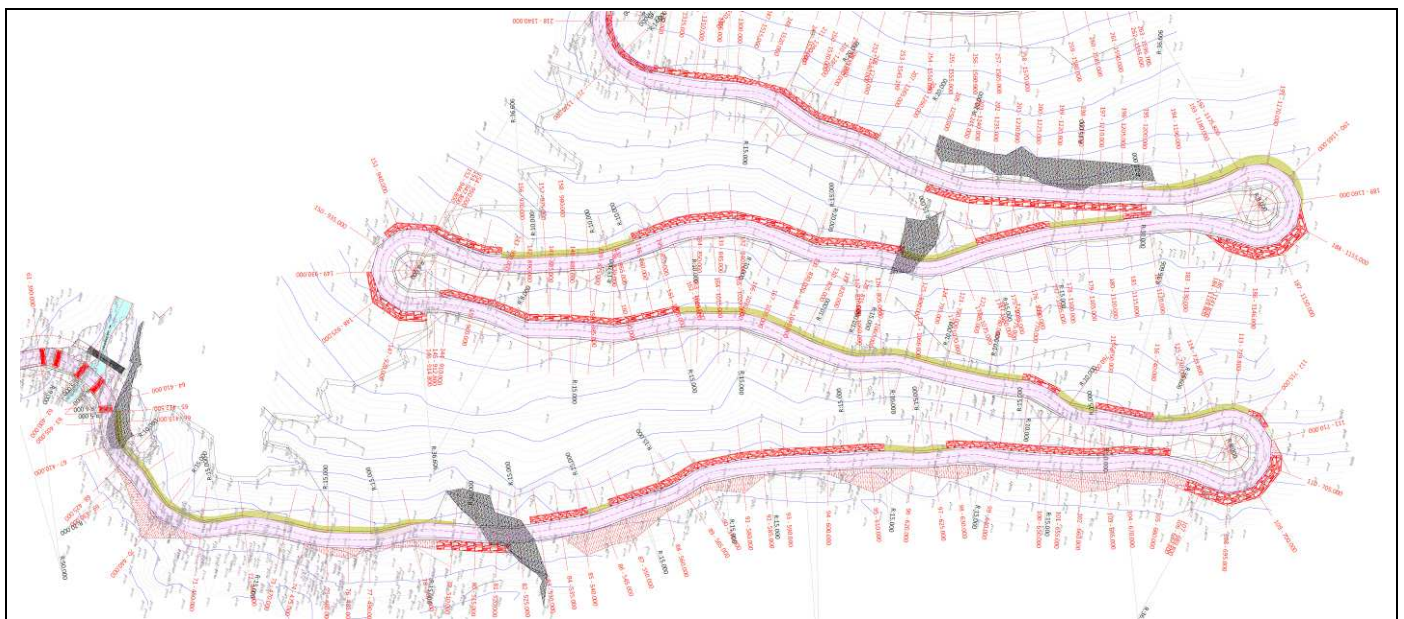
estratto planimetrico tratto attraversamento val Bolgadregna [tavola B3 Studio Maraffio]
